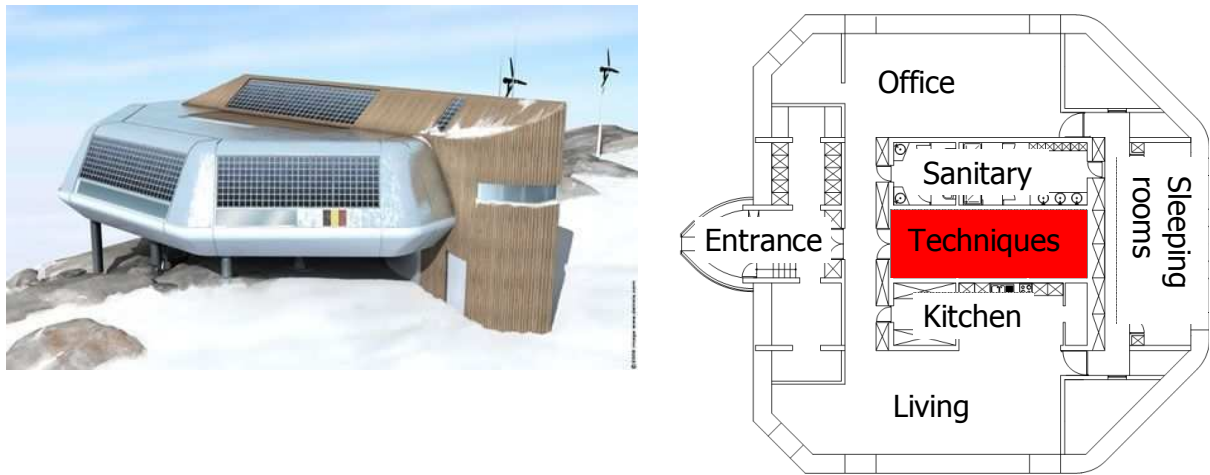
plan de disposition générale du bâtiment (la grille est de 5m par 5m)
